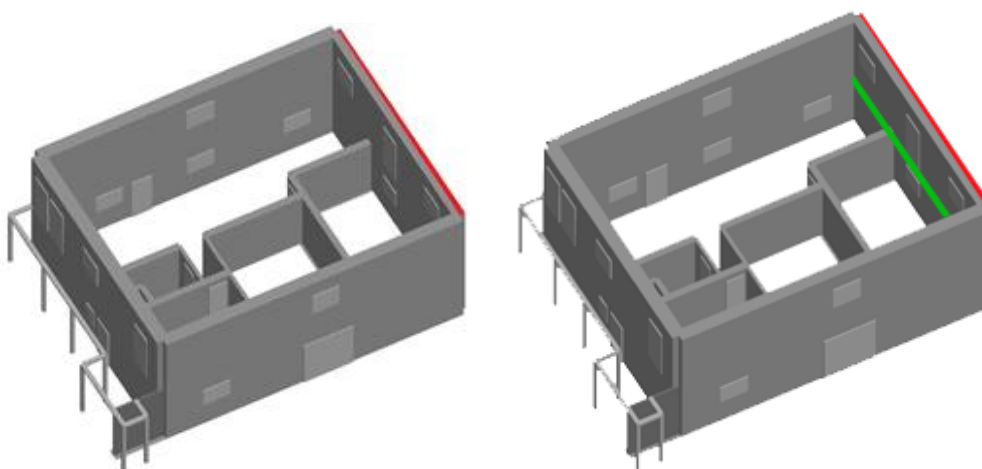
Comparação da execução de reboco armado numa face da fachada principal com a solução conjunta de introdução de tirantes ao nível do pavimento do piso 1 e execução de reboco armado numa face da mesma fachada
